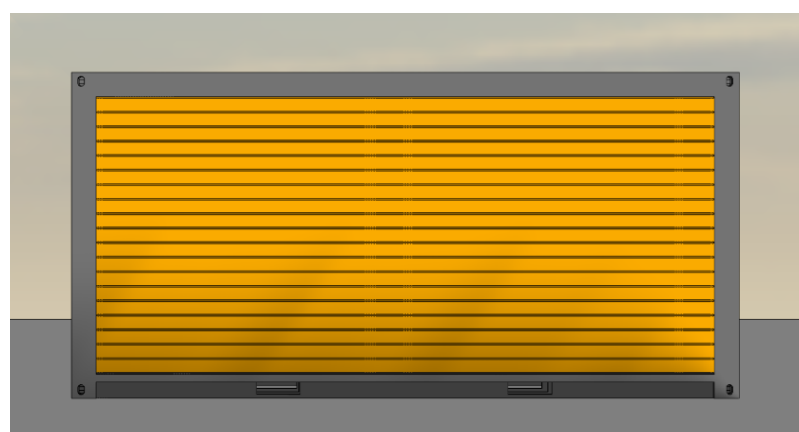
Vue de la façade latérale avec percement sur le bureau
